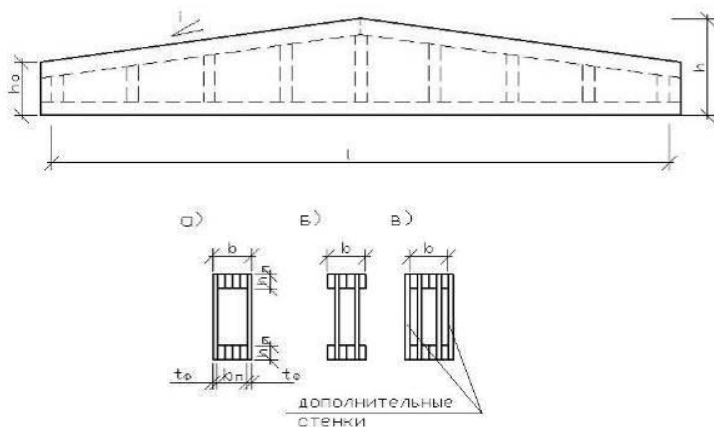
Общий вид клефанерной балки с поперечным сечением:
